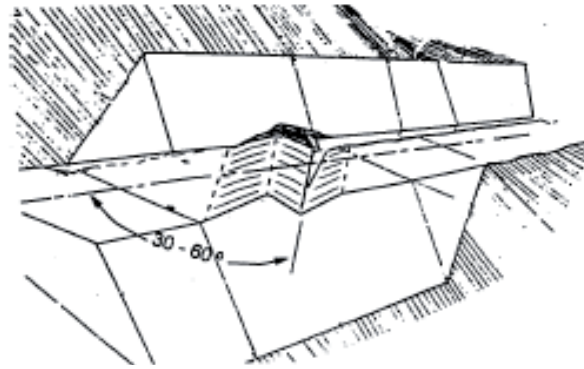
Detalle de un caballón desviador dotándolo de un ángulo respecto del talud de 30-60°. Fuente: Warren Ch. Water bar placement and construction guide for Siuslaw Forest roads.
